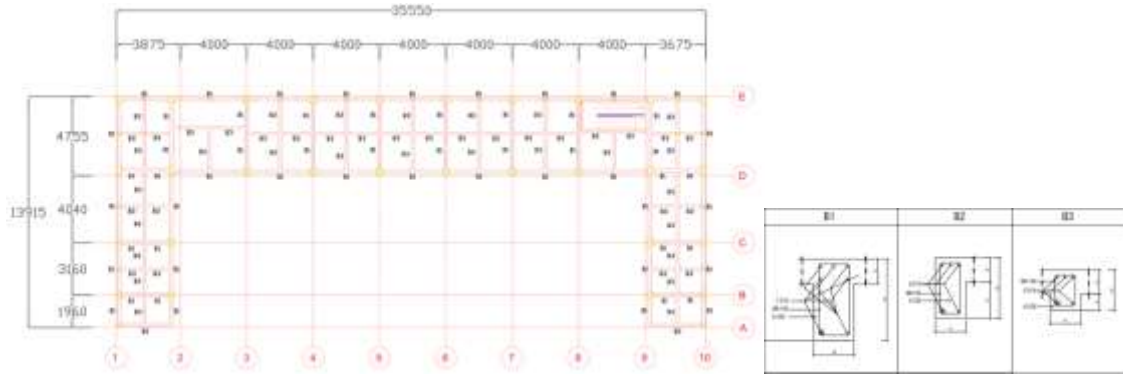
Denah dan Detail kolom dan kolom praktis (Lantai 1-3) Bangunan Sekolah
